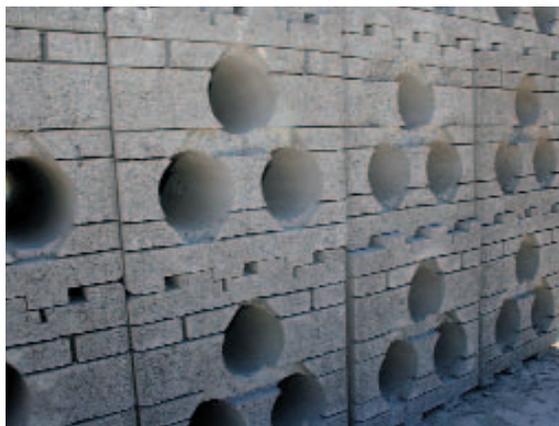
Геоблок: крупногабаритный блок, предназначенный для строительства сверхпрочных стен.
